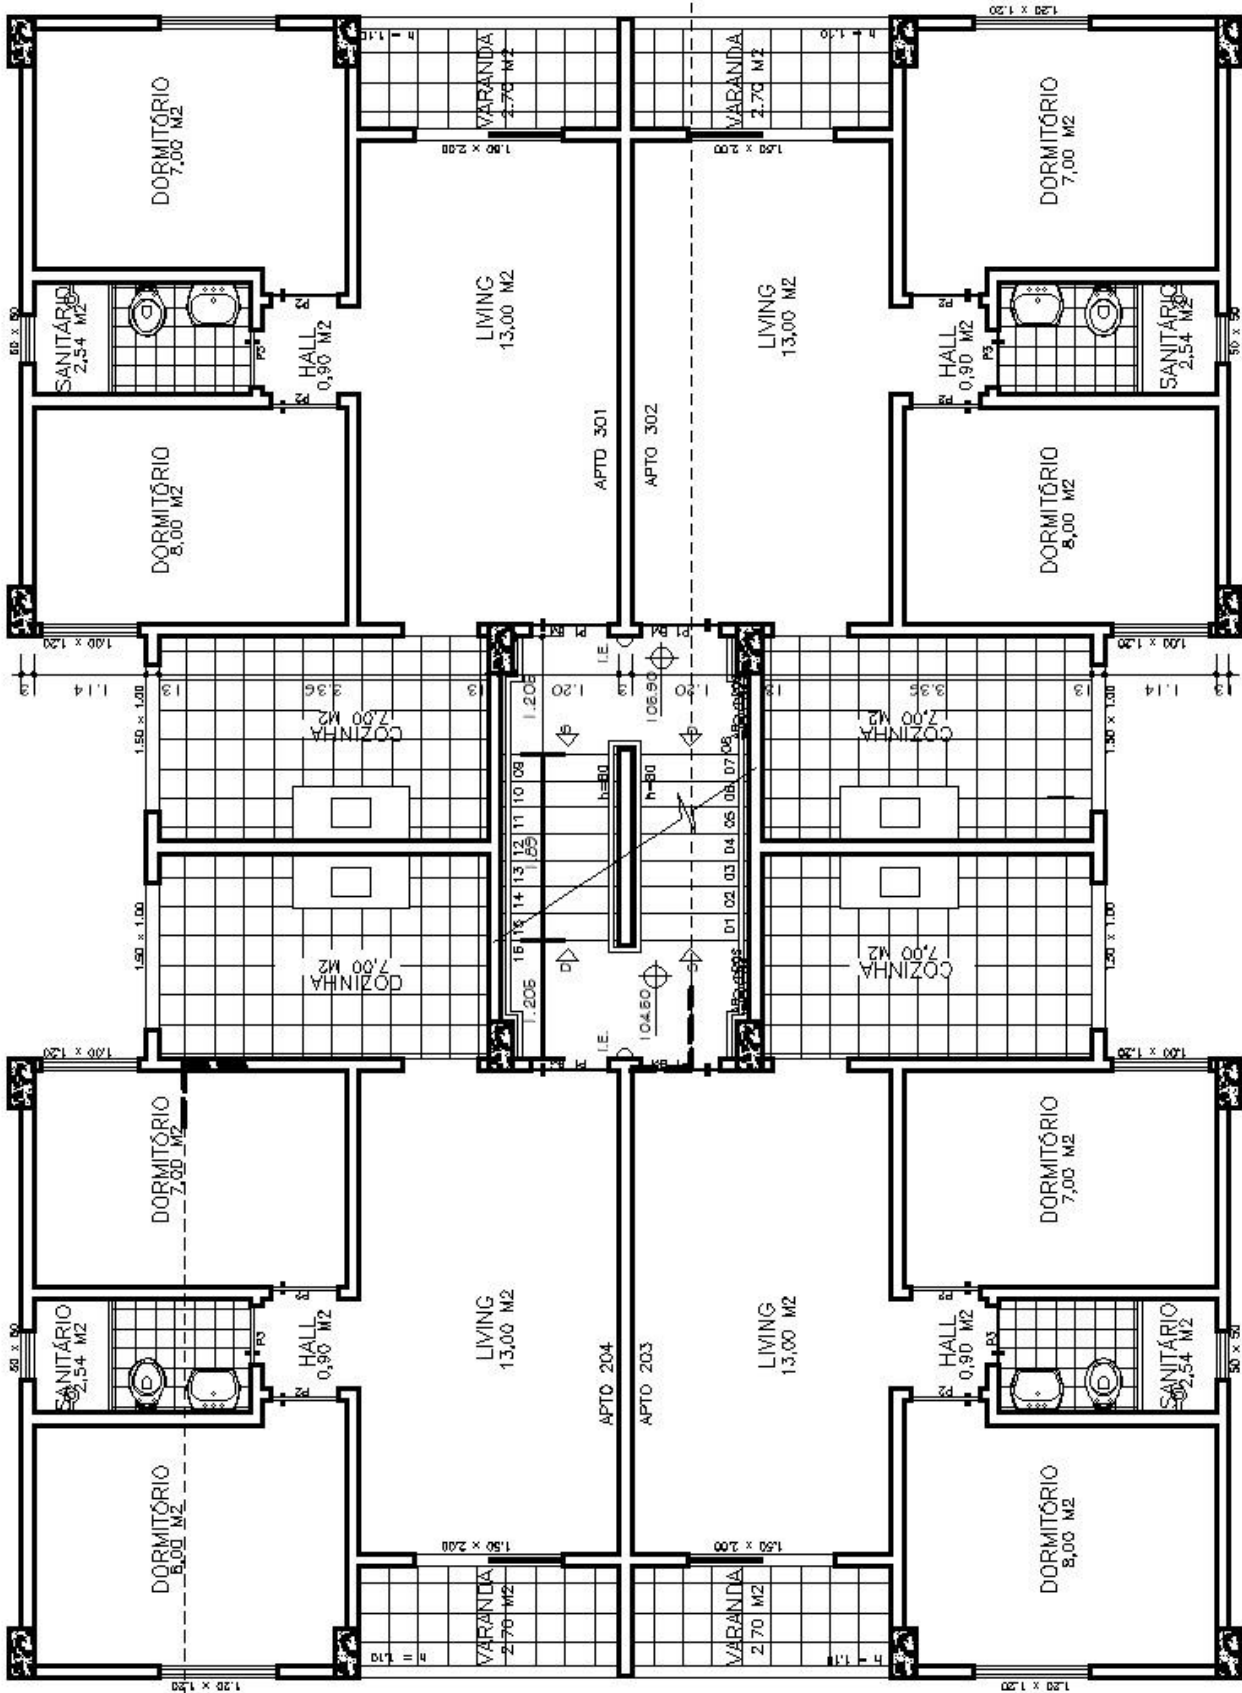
Planta baixa do pavimento tipo do projeto padrão usado na determinação da variável aleatória ação permanente.
